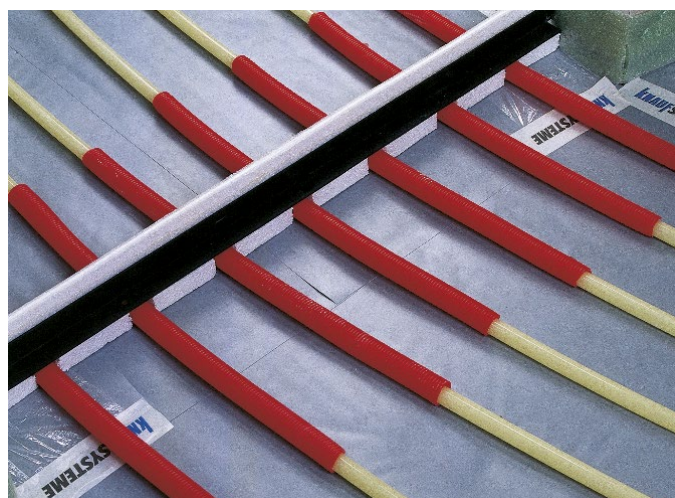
Joint de tassement dans une chape chauffante, type A, à l'embrasure de porte
